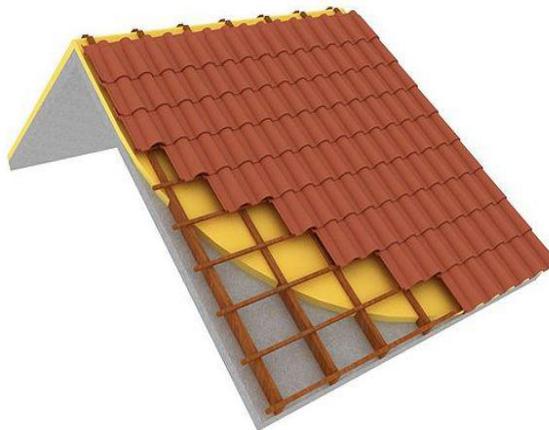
Cubierta con aislamiento de Poliuretano Proyectado.
